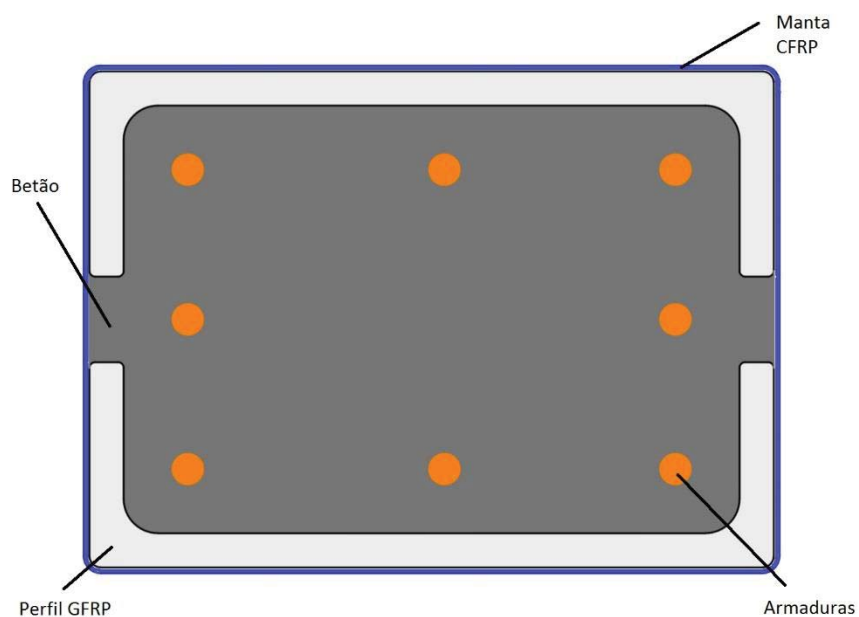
Secção mista (GFRP, betão armado e CFRP)
